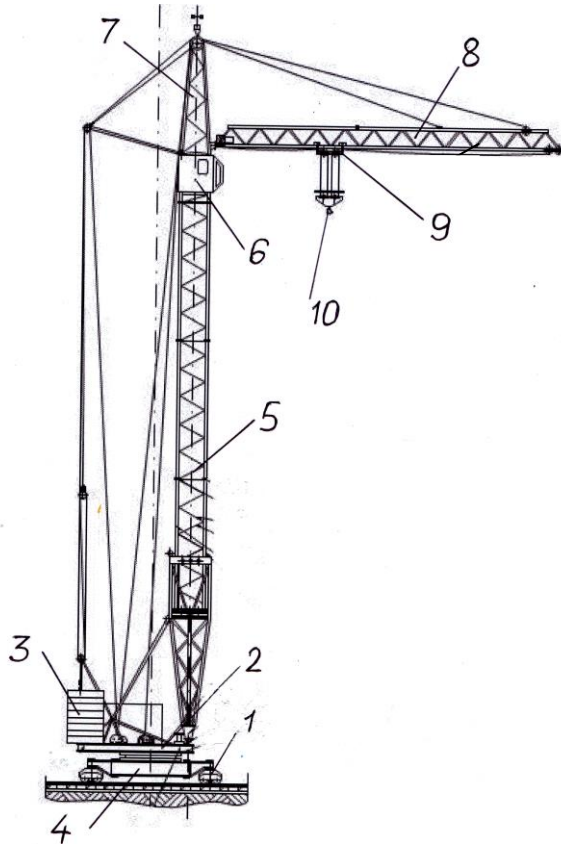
Башенный кран: 1 – ходовое устройство; 2 – поворотная платформа; 3 – балласт; 4 – портал; 5 – башня; 6 – кабина крановщика; 7 – оголовок; 8 – стрела; 9 – каретка; 10 – крюк
